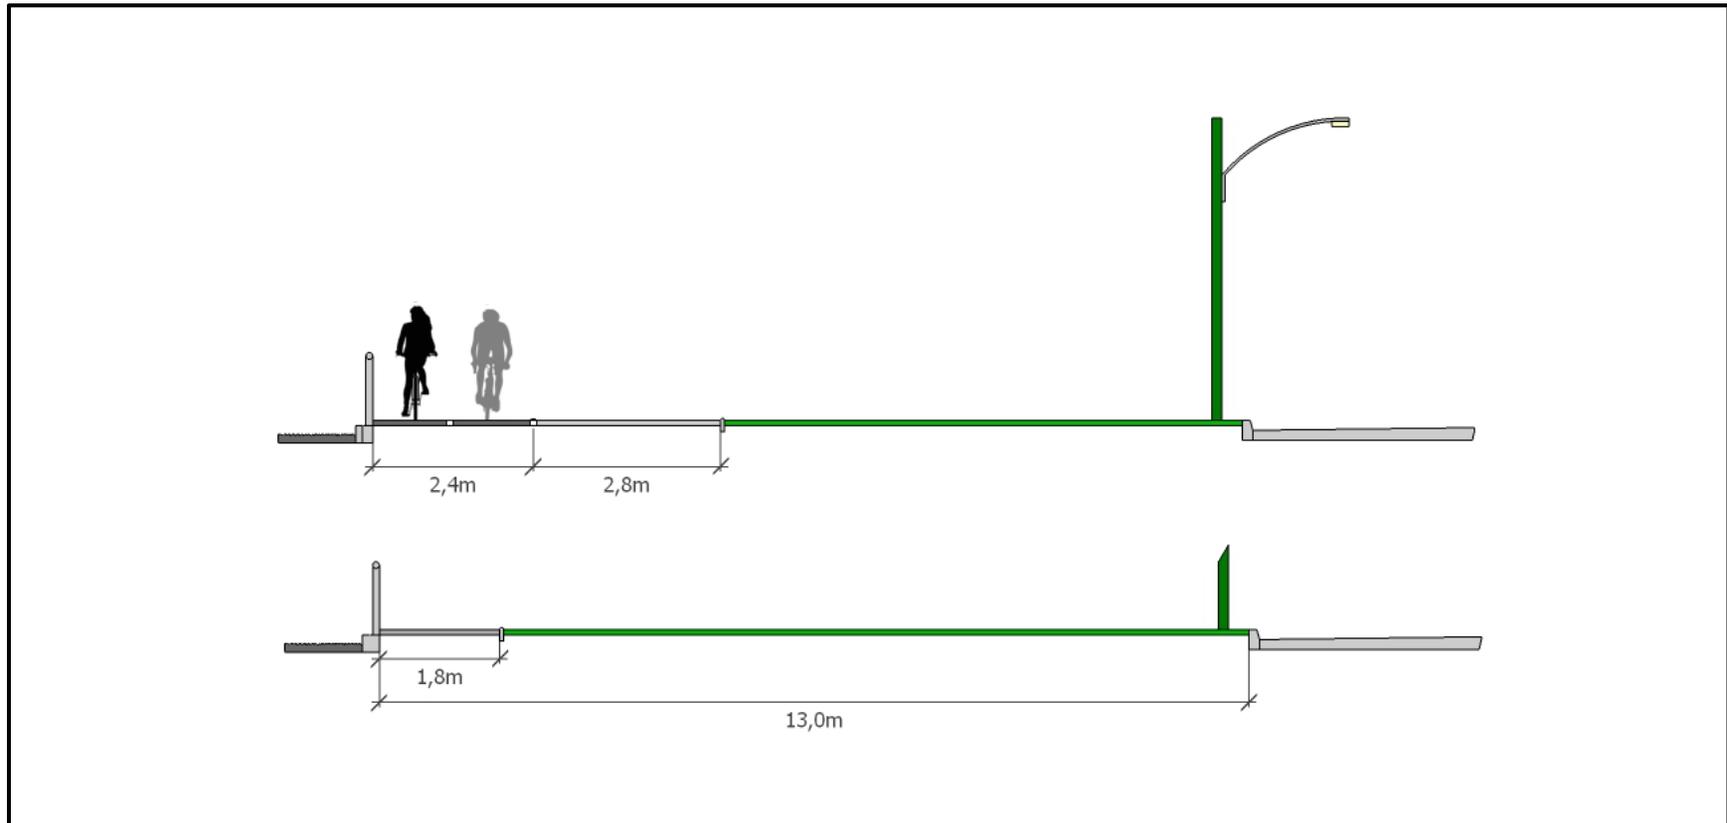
Nuevo Perfil Transversal Eje A (Av. España) / Sector A2 / 2 (antes-después)
